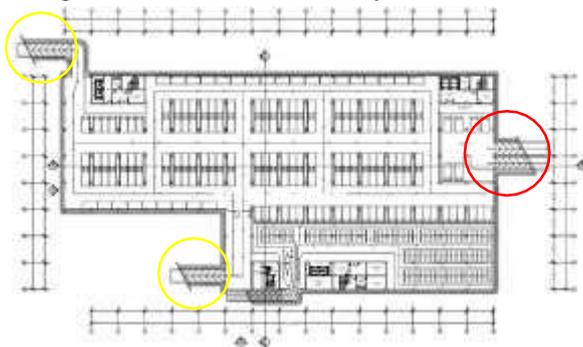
Pola Sirkulasi Detail Site Plan
